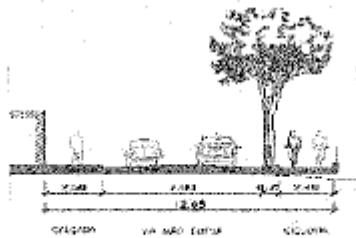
Rua Avenida Tenente Galvão – Situação Projetada
